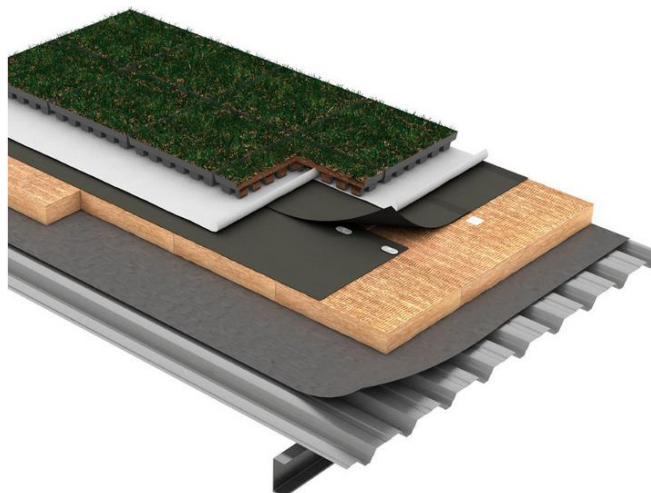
Detalhe construtivo da cobertura DeckRock Ajardinada, [89].
